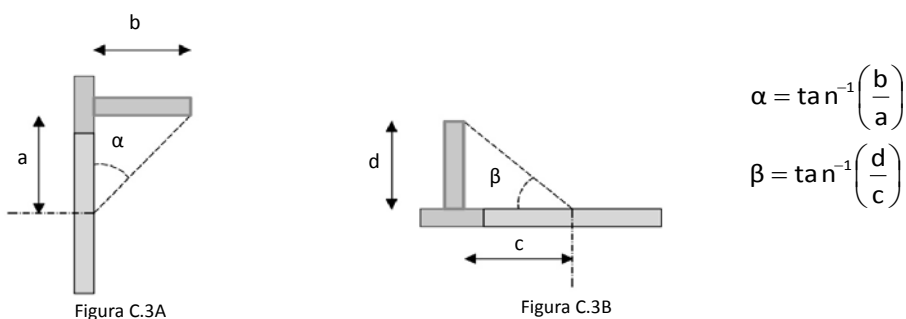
Superfici trasparenti con aggetti orizzontali e verticali (A: sezione verticale; B: sezione orizzontale)
